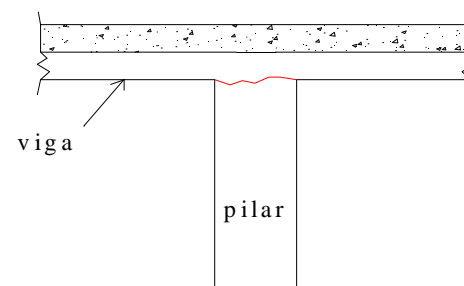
Fissuras de junta de concretagem (modificada de HELENE,1992)
